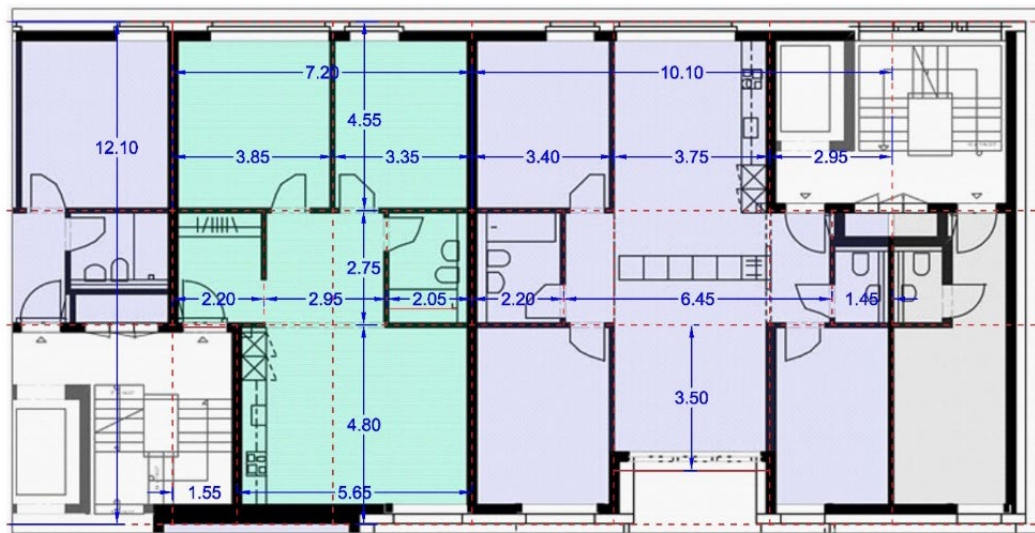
Exemplarischer Grundriss anhand einer Wohnung der städtischen Wohnsiedlung Leutschenbach
